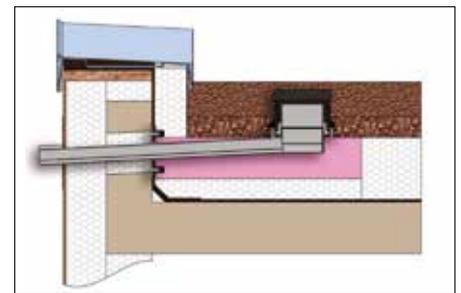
Dachentwässerung und Notablauf eines Umkehrdaches.
